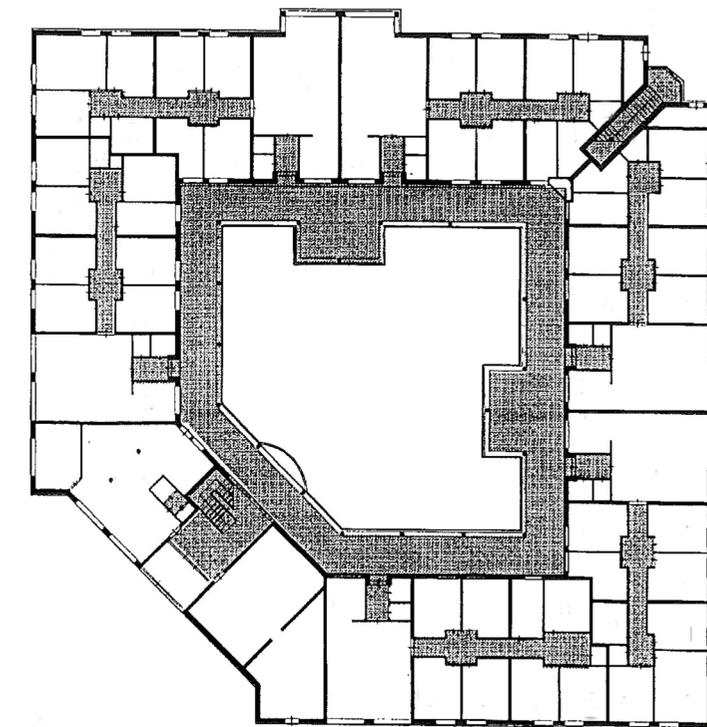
Grundriss Anton-Pieck Hofje
